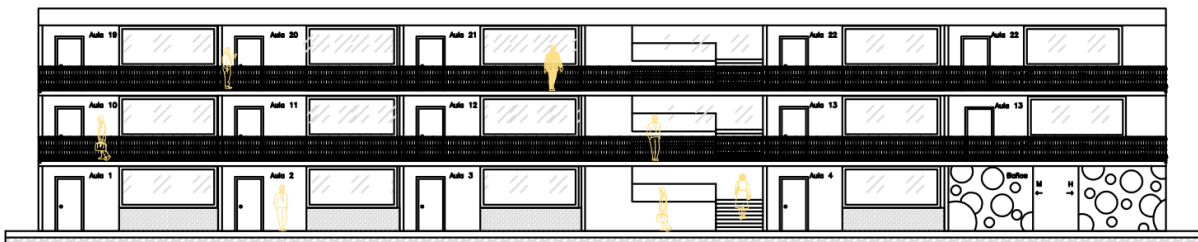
Fachada Frontal Edificio Escolar/Artes y talleres
